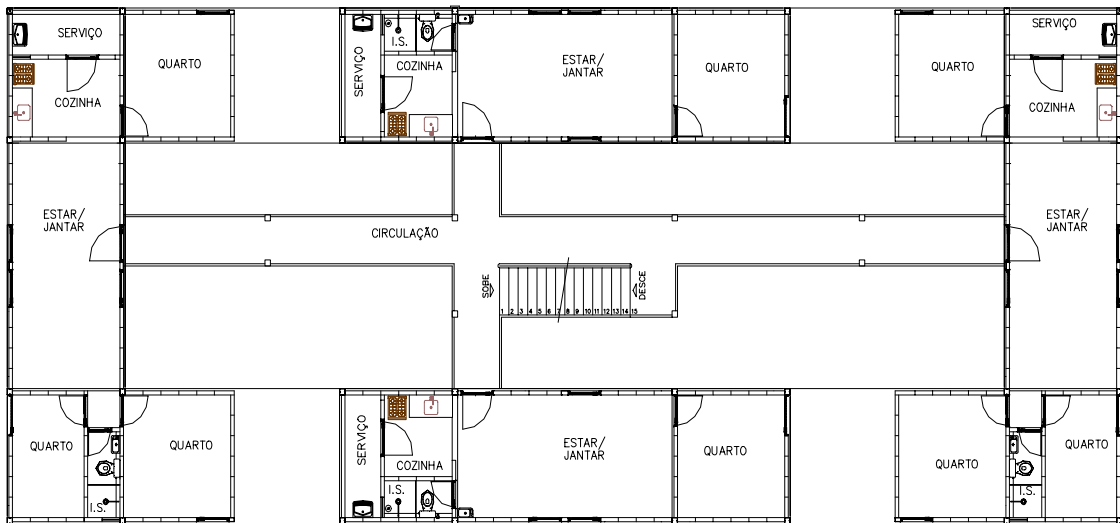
Planta baixa do 3º pavimento do Projeto 02 (Protótipo USIHAB, 2001).
